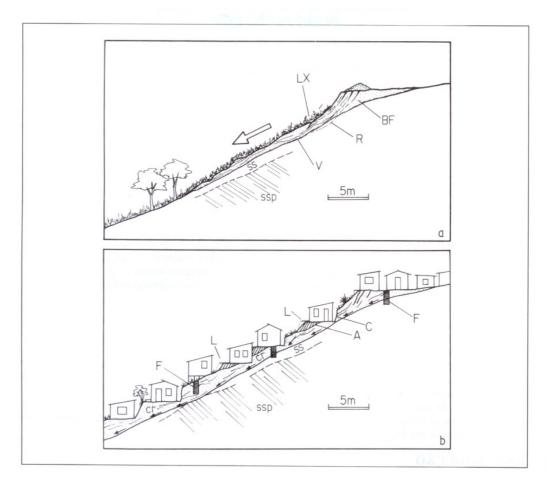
(referência nossa)— Perfil esquemático de instabilização de encostas ocupadas por moradias de baixo padrão construtivo em patamares de corte e aterro..
